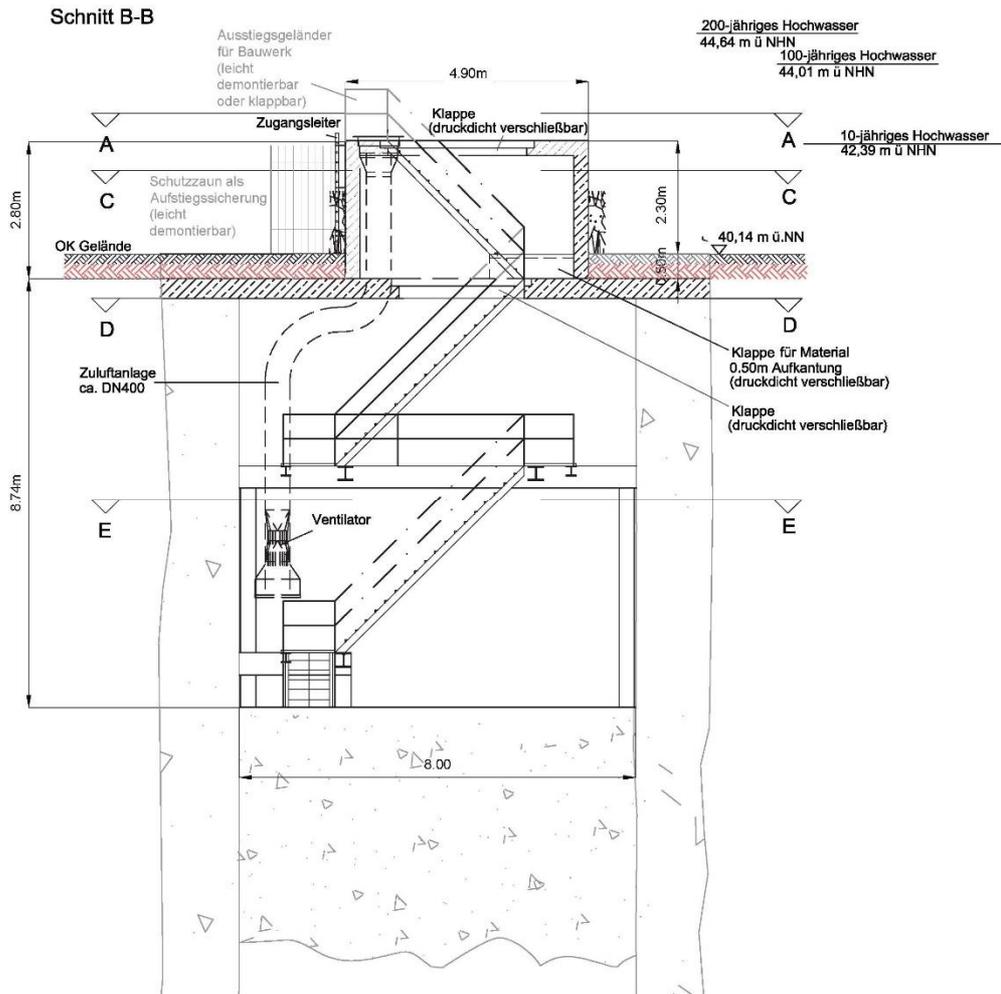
Zielschachtbauwerk mit oberirdischem Bauwerksteil (Schnitt)
